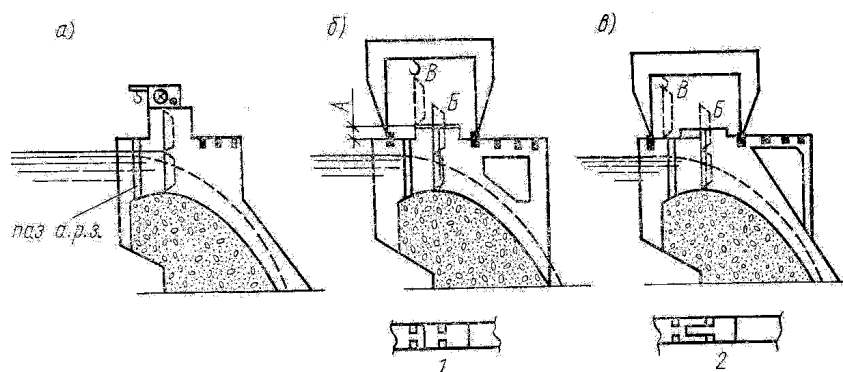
Схемы очертания верхней части быков (вид сбоку):
